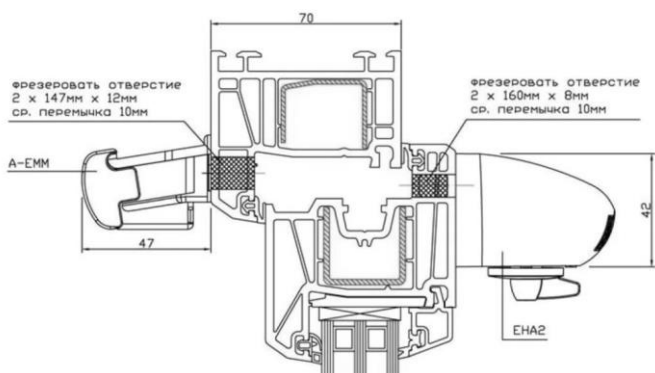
Шаблон фрезеровки для установки автоматического клапана Аегесо.
